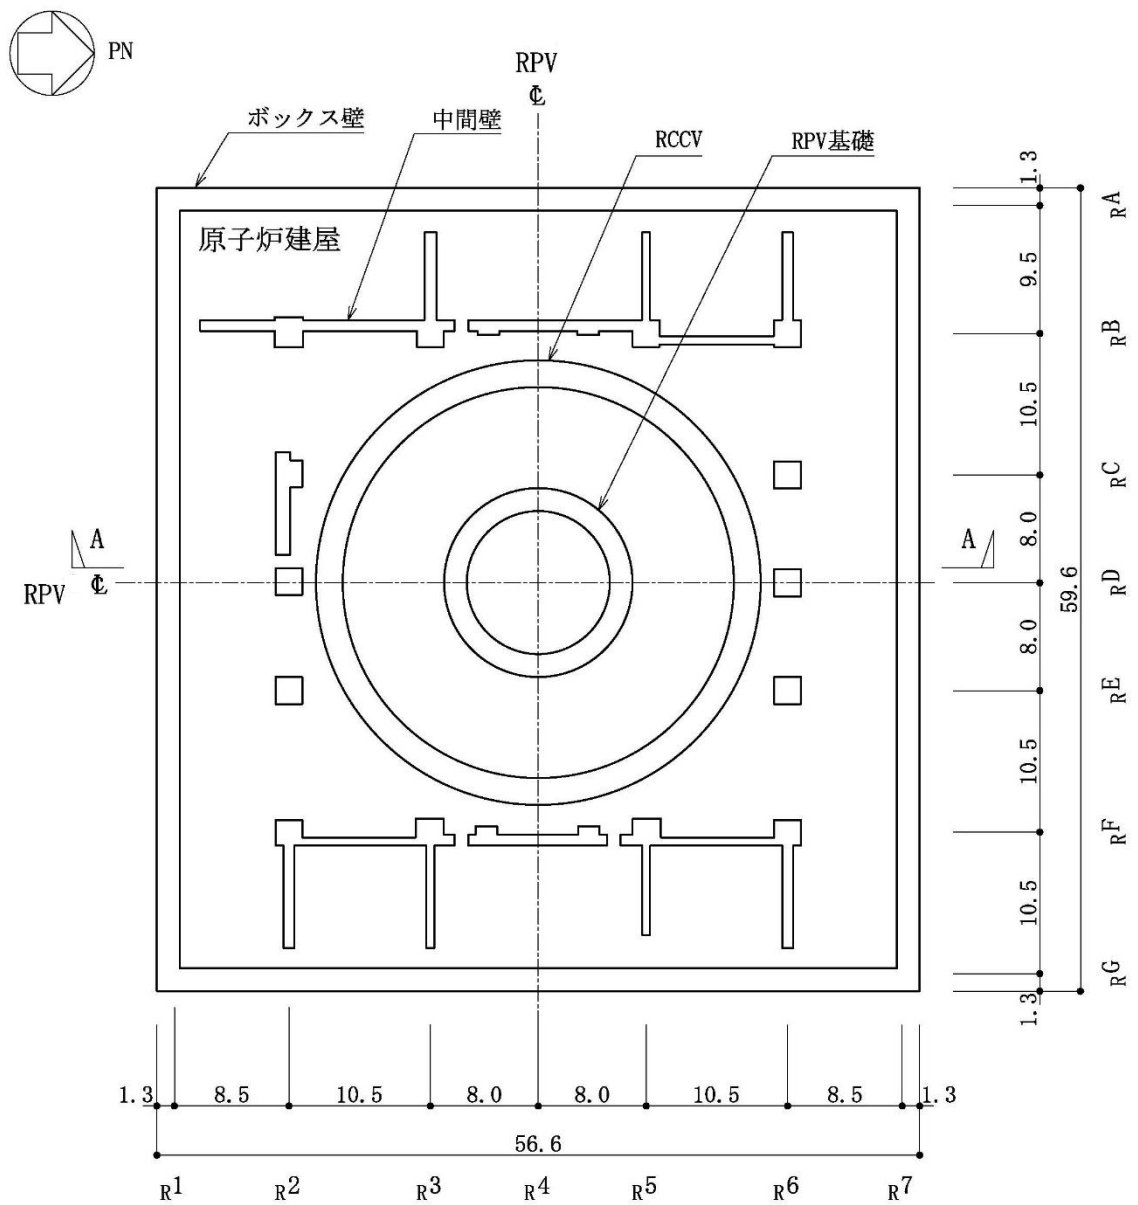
原子炉建屋基礎スラブの概略平面図 (T.M.S.L. -8.2m) (単位 : m)
